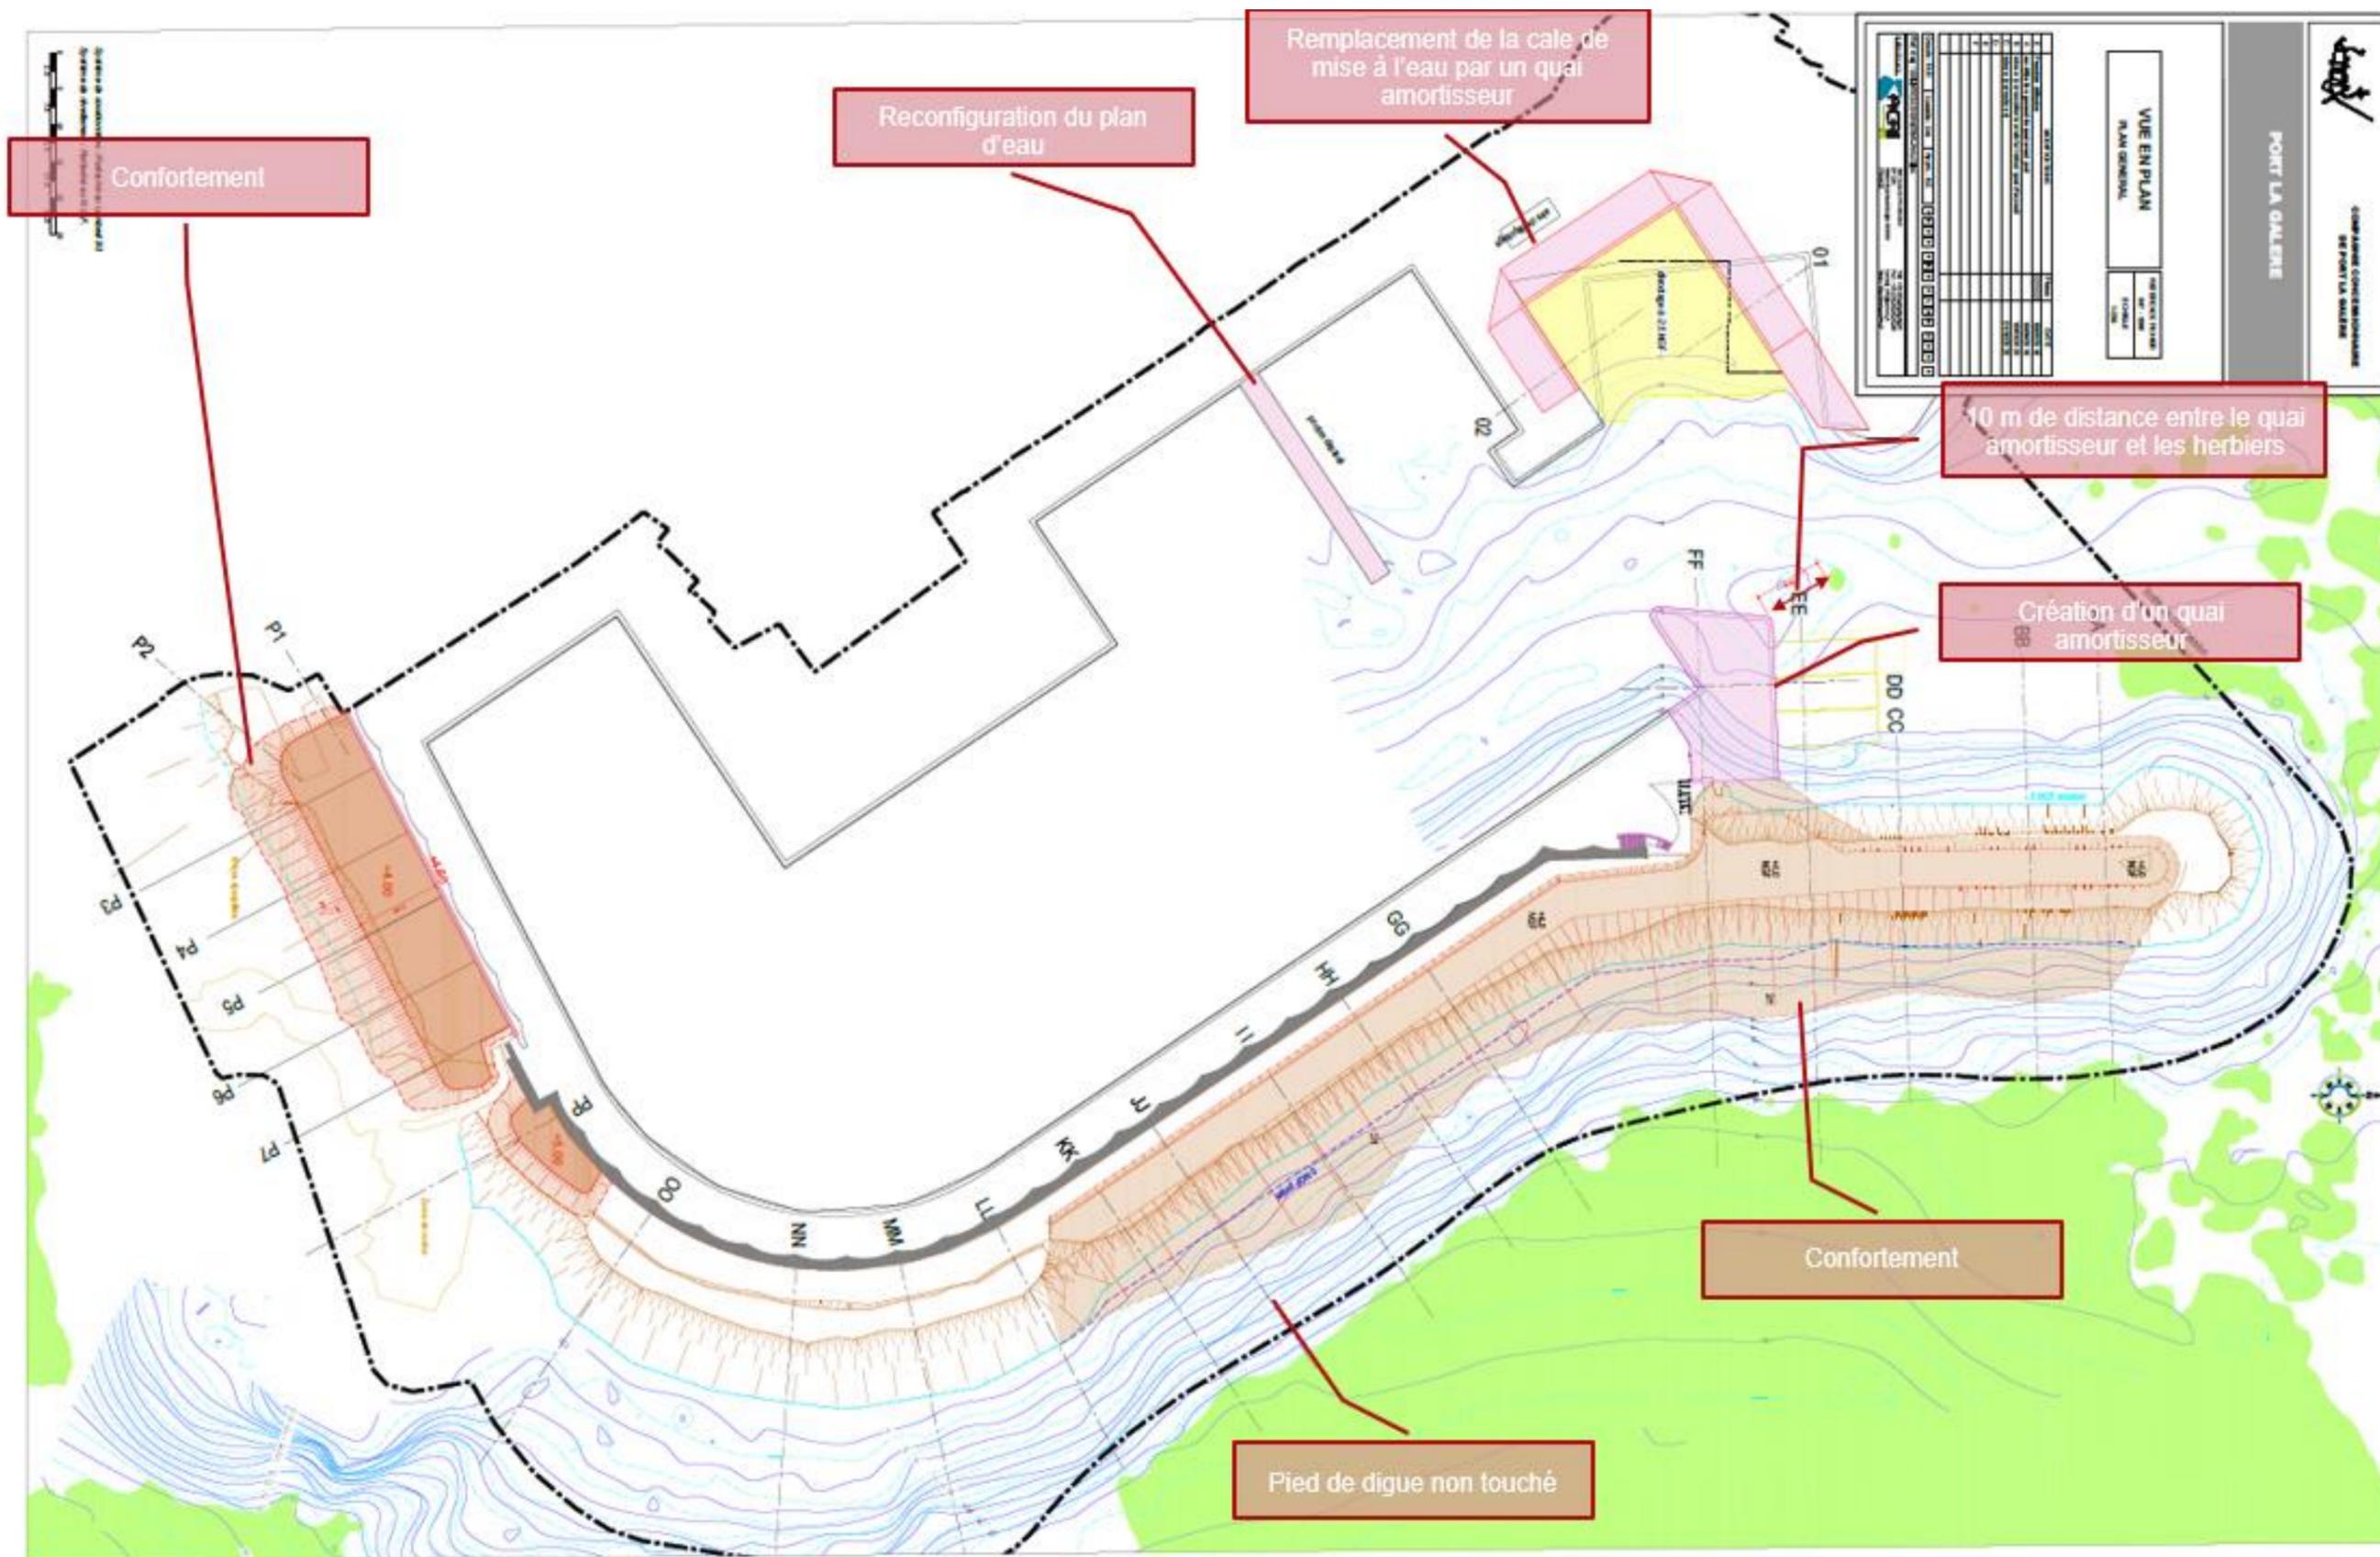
Vue en plan général du projet (ARCI IN 2021)
